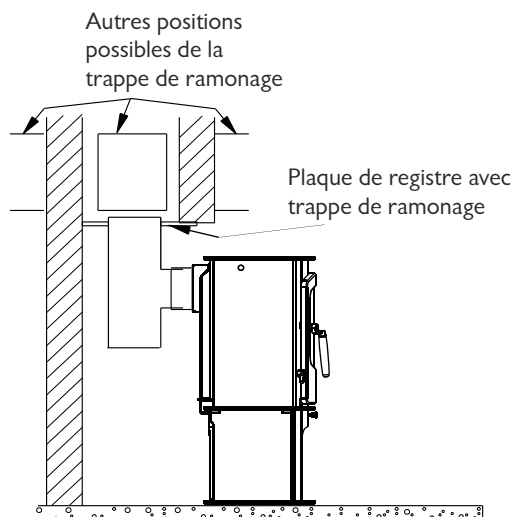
Plaque de registre horizontale avec branchement de conduit de fumée par le haut
